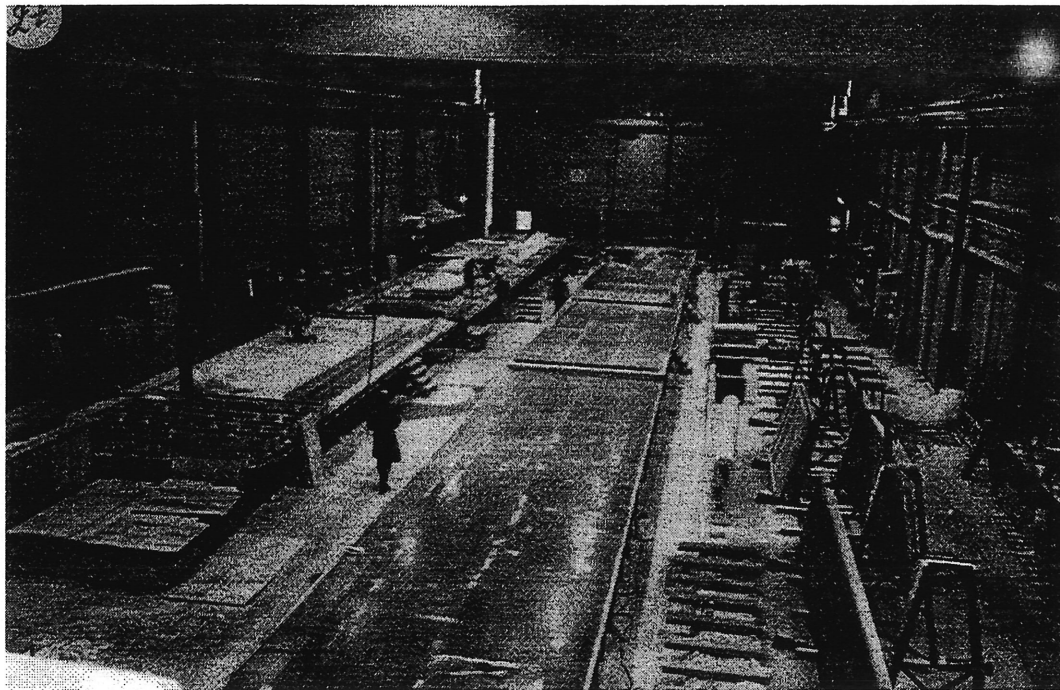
Hall d'essai de l'usine de préfabrication, avec préparation des coffrages sur tables vibrantes.
